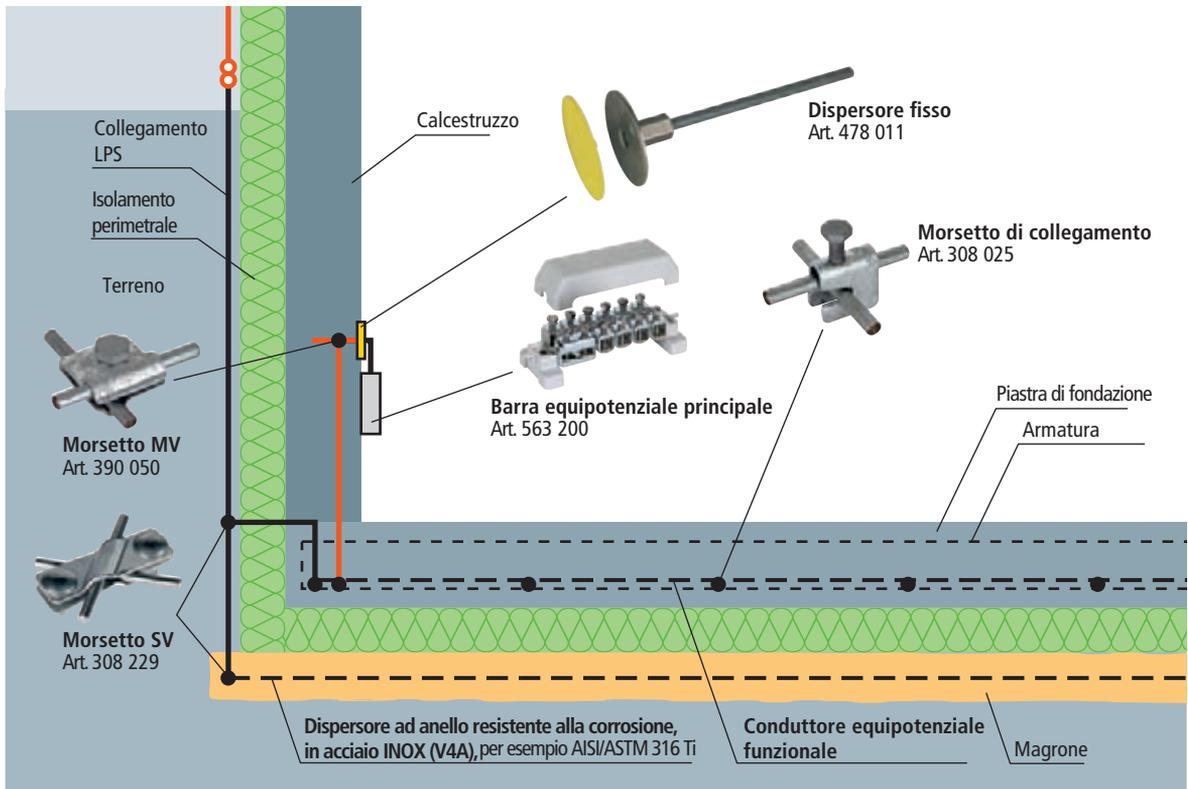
Disposizione del dispensore di fondazione con platea di fondazione chiusa (completamente isolata)
